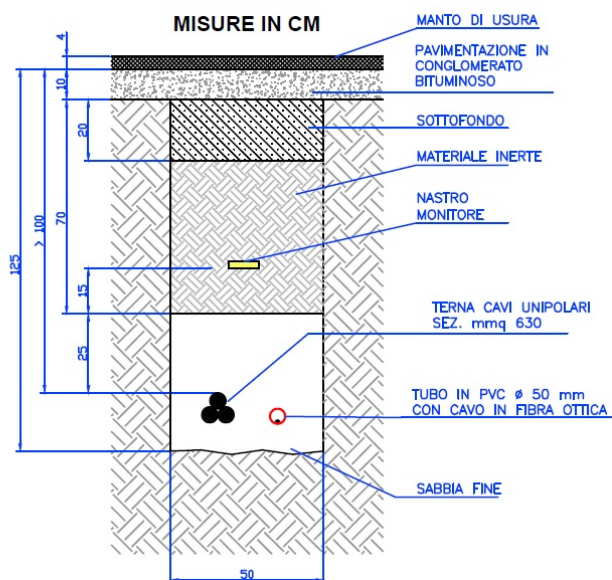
Sezione tipo cavidotto con terna di cavi unipolari su strada asfaltata estraparco
